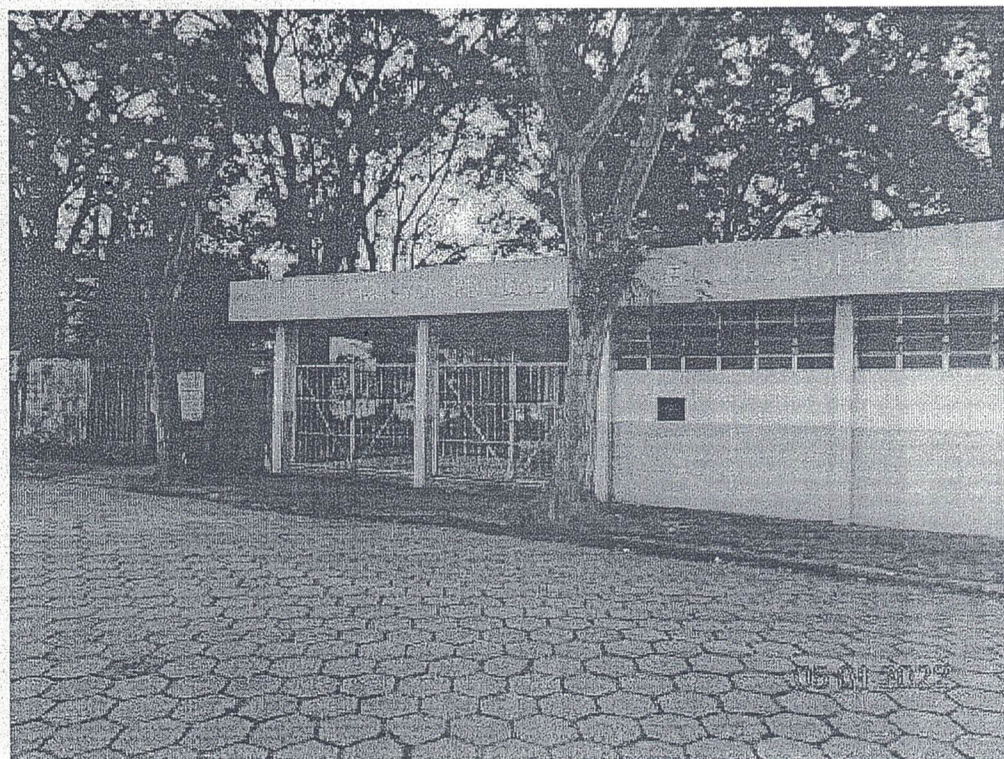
Outra vista parcial da frente do Centro Educacional e Desportivo de Cubatão Prof. Roberto Dick, localizado à Rua Bernardo Pinto nº 188.
